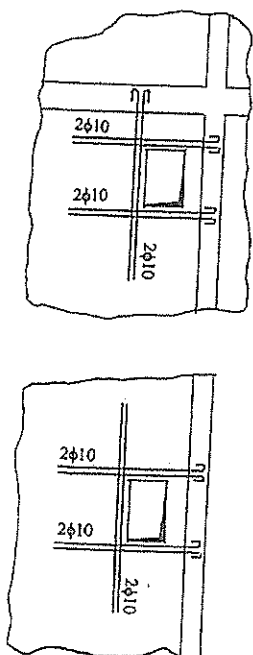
Reforço de abertura em lajes armadas em duas direções
